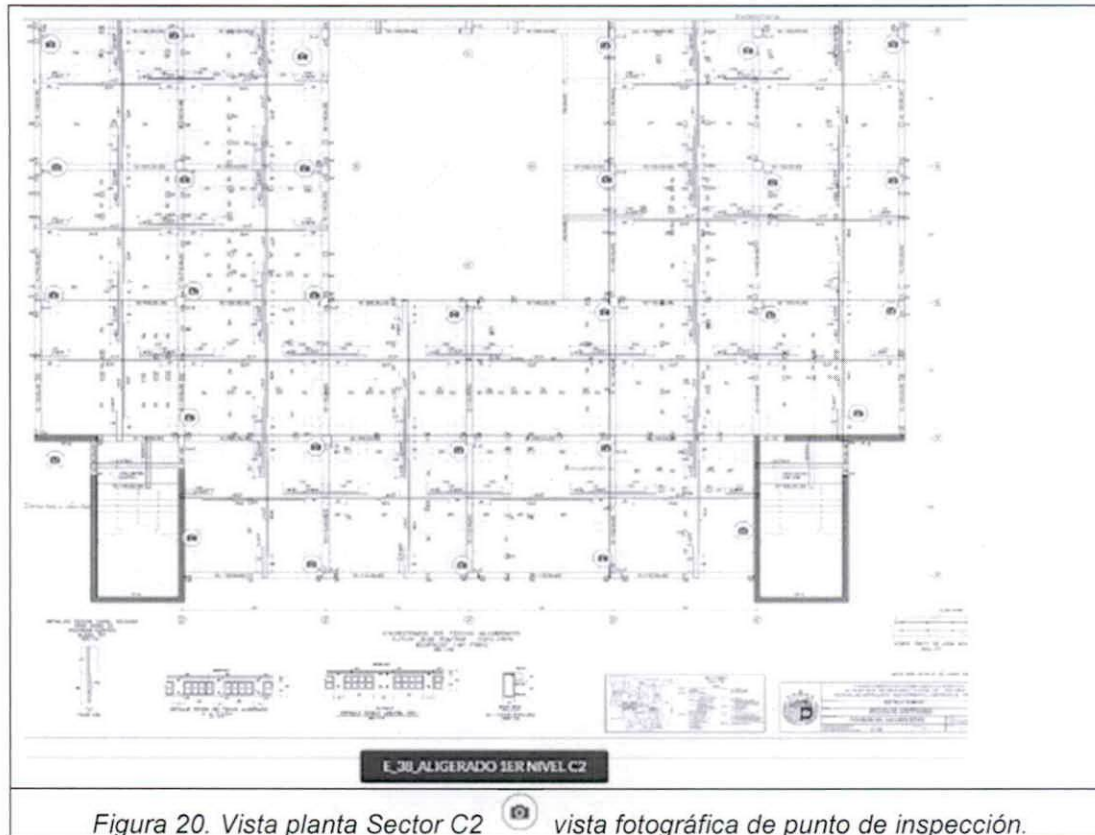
Vista planta Sector C2  vista fotográfica de punto de inspección.
